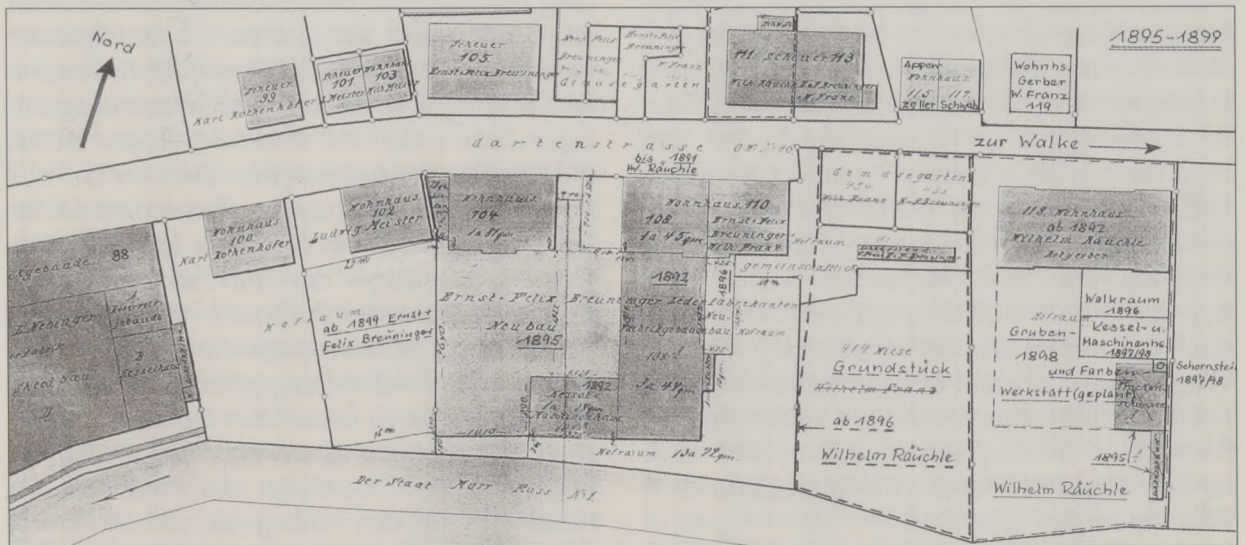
Lageplan von der Gartenstraße mit den Lederfabriken Felix Breuninger und W. Rächle.
